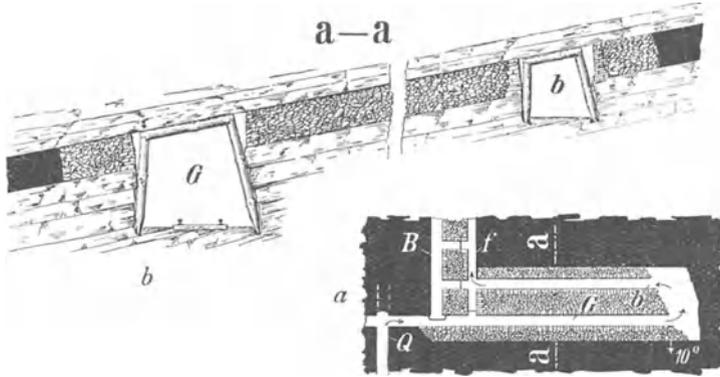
a und b. Breitauffahren einer Grundstrecke bei flacher Lagerung im Grundriß (a) und Profil (in vergrößertem Maßstabe) nach a—a (b).
